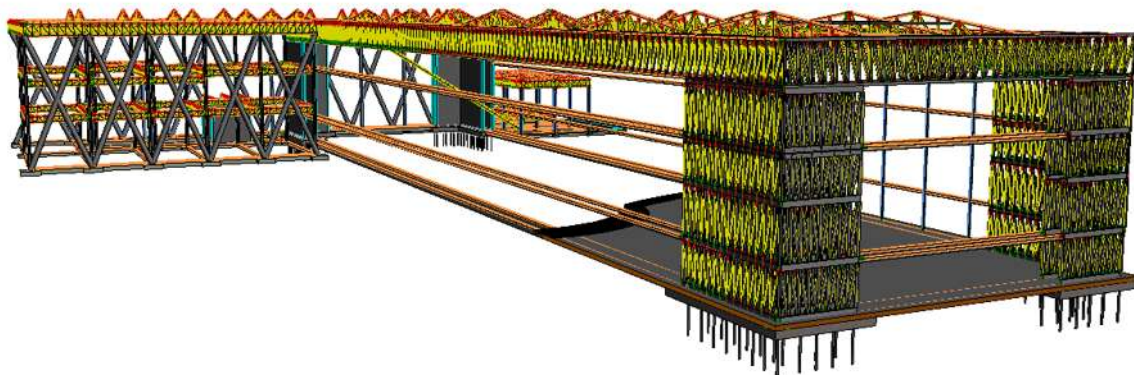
Perspectiva de la estructura metálica propuesta para el edificio. Elaboración propia.
